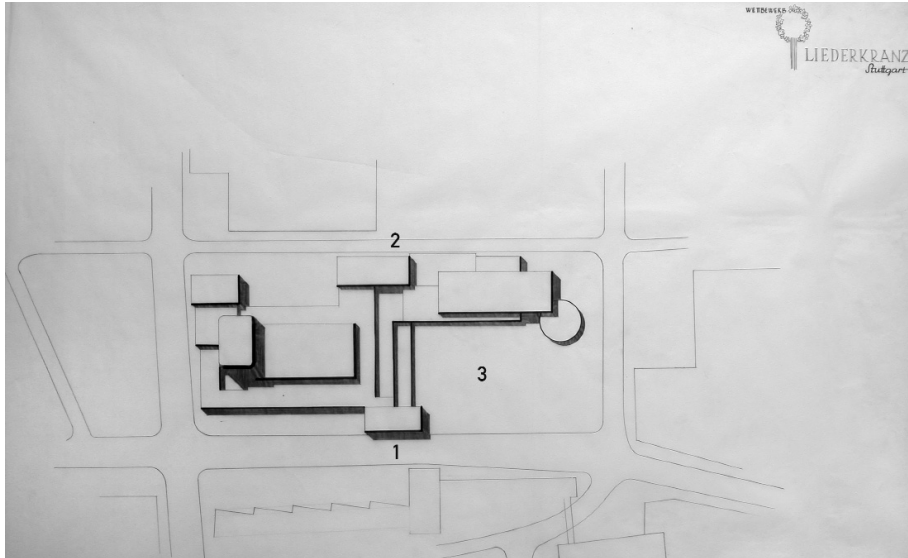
Wettbewerb Lageplan, Abel/Gutbrod, 1949.
